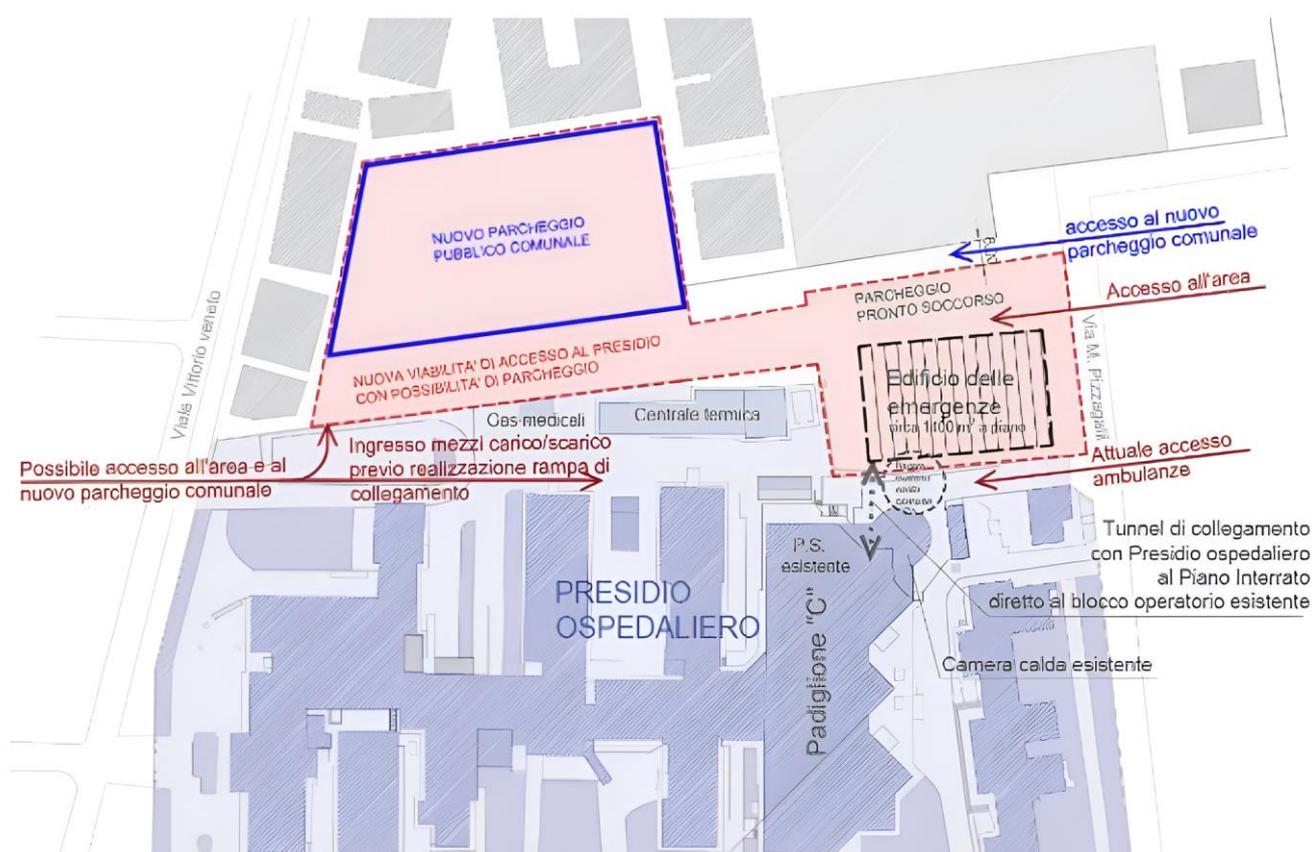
Planimetria dello stato di fatto con identificazione dell'area intervento e delle connessioni di progetto.
